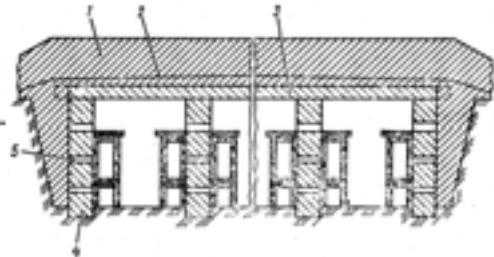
Трехпролетное убежище из сборного железобетона с вертикальными стенами из железобетонных блоков: 1 – насыпной грунт; 2 – гидроизоляция; 3 – железобетонная плита; 4 – стена из бетонных блоков; 5 – цементный раствор
